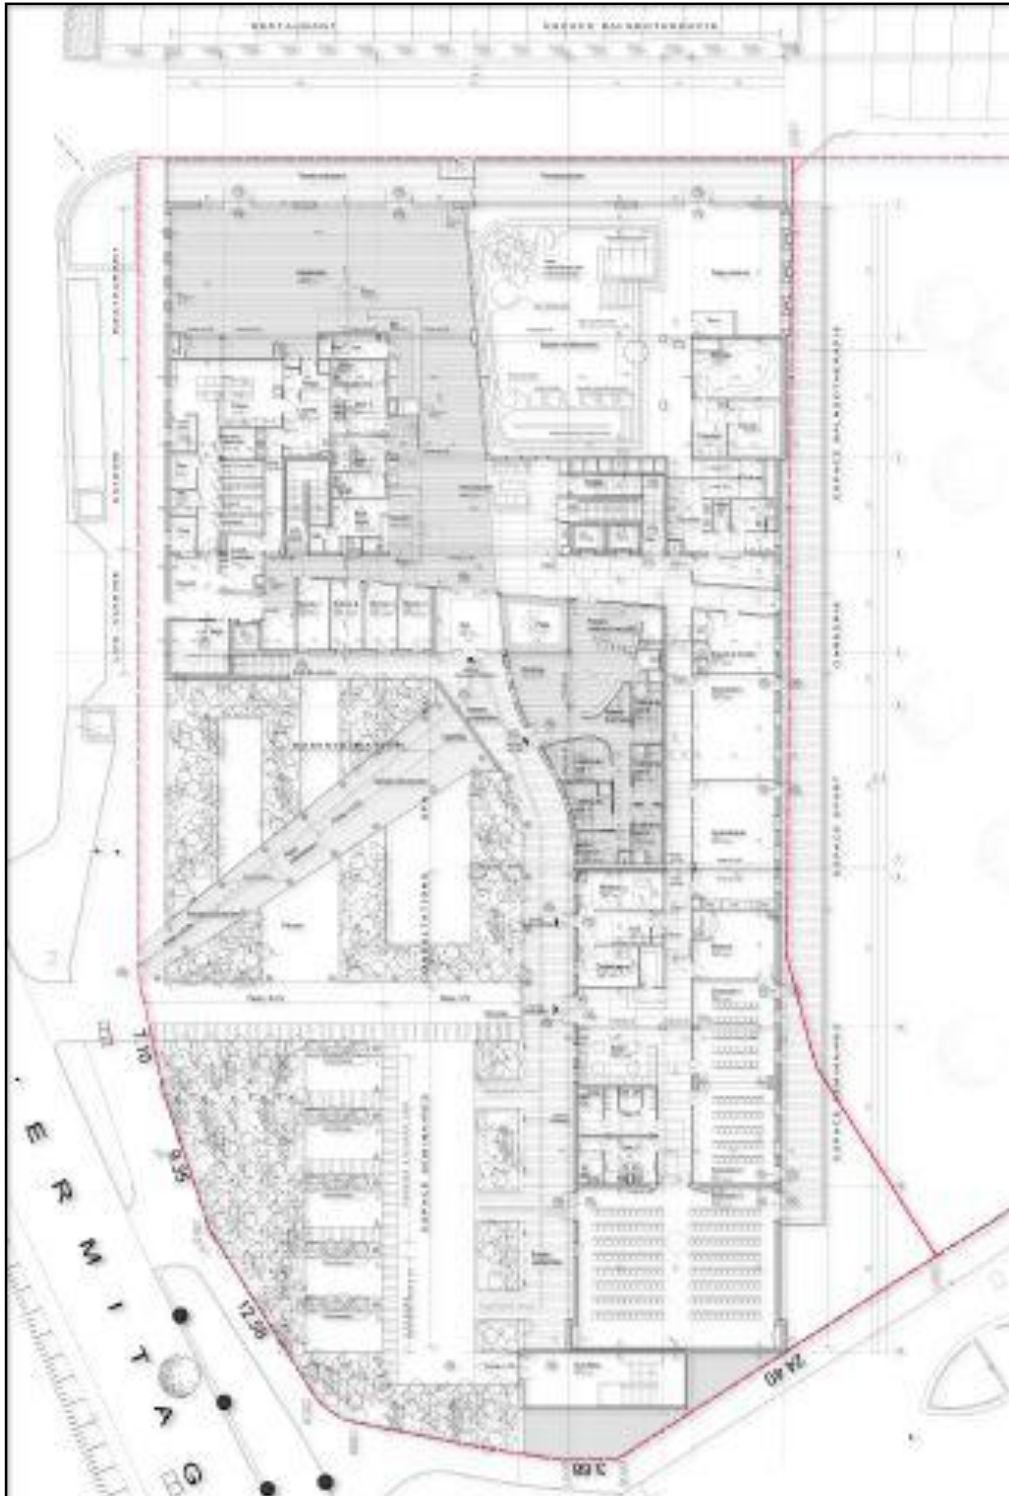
plan Du rez de chaussée du centre de thalassothérapie Donville-les-bains
